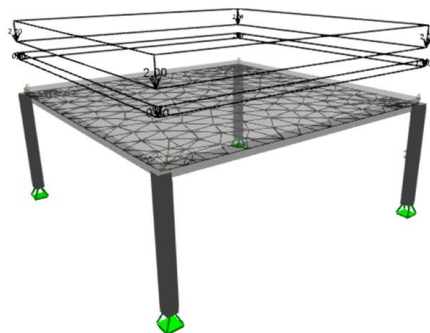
ADPE for konstruksjonene, 4x4 [m]
